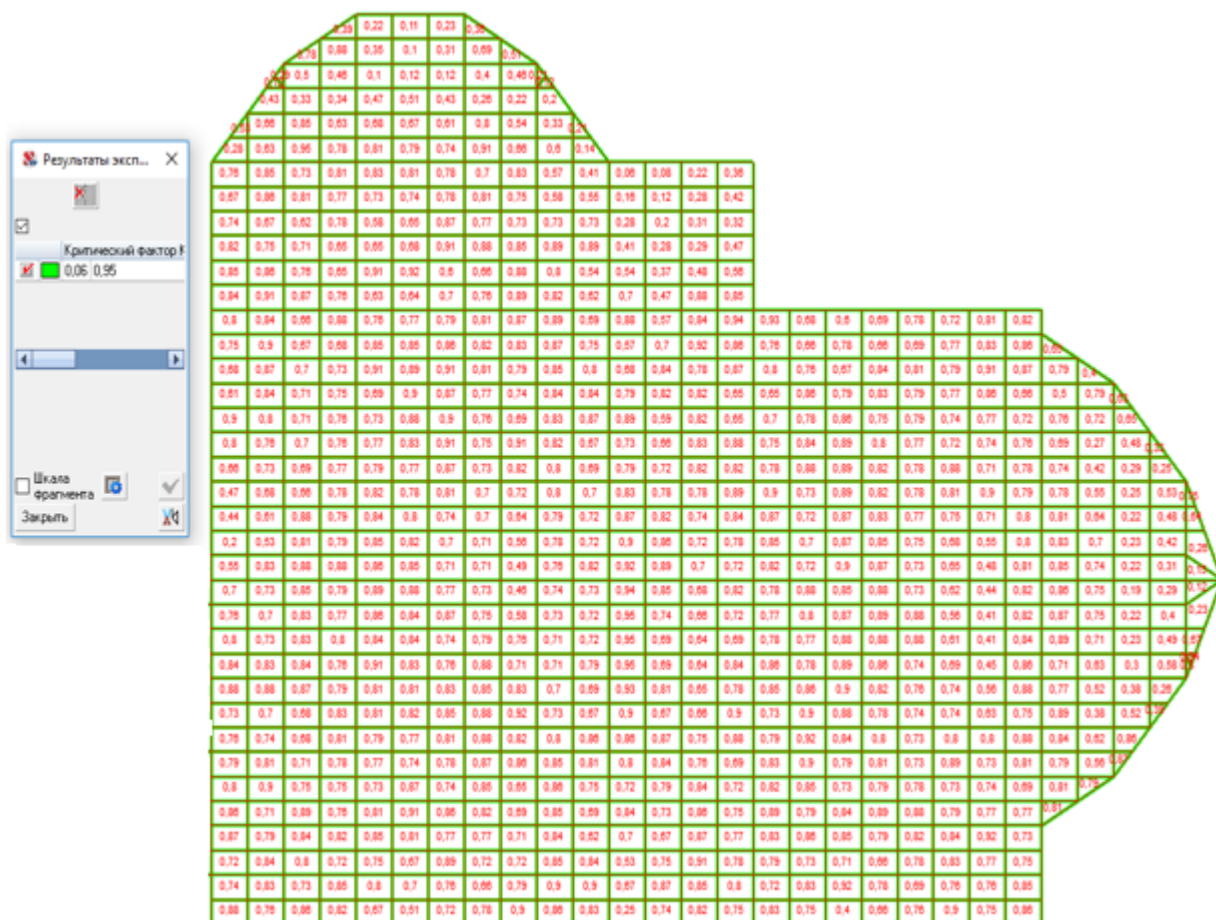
Результаты проверки подобранного армирования плиты перекрытия ПК SCAD
